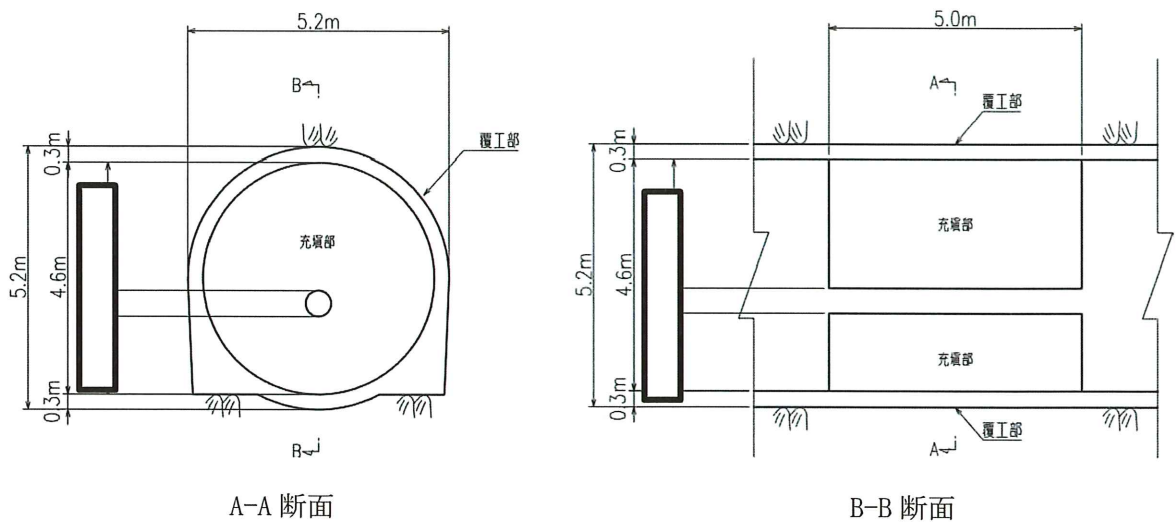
(2) 取放水路流路縮小工（第1号機放水路） 断面図
